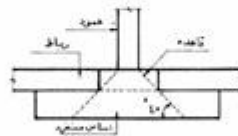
مقطع ومخطط اساس عمود مع رباط من الخرسانة المسلحة
